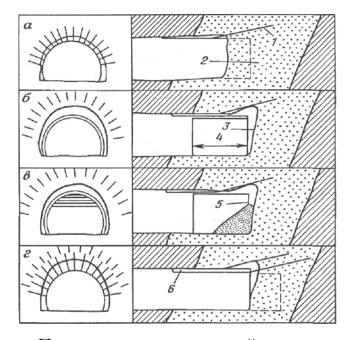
Пересечение нарушенной зоны с применением опережающей анкерной крепи (подводный тоннель Вардо, Норвегия): а - возведение бетонной обделки и установка опережающих анкеров; δ - нанесение набрызгбетона и установка опалубки; в - бетонирование; установка следующей очереди опережающих анкеров; опережающая анкерная крепь; 2 зона нарушенных пород; 3 - набрызгбетон; 4 -несущая ферма опалубки; 5 -опалубка; 6 - бетонная облелка
